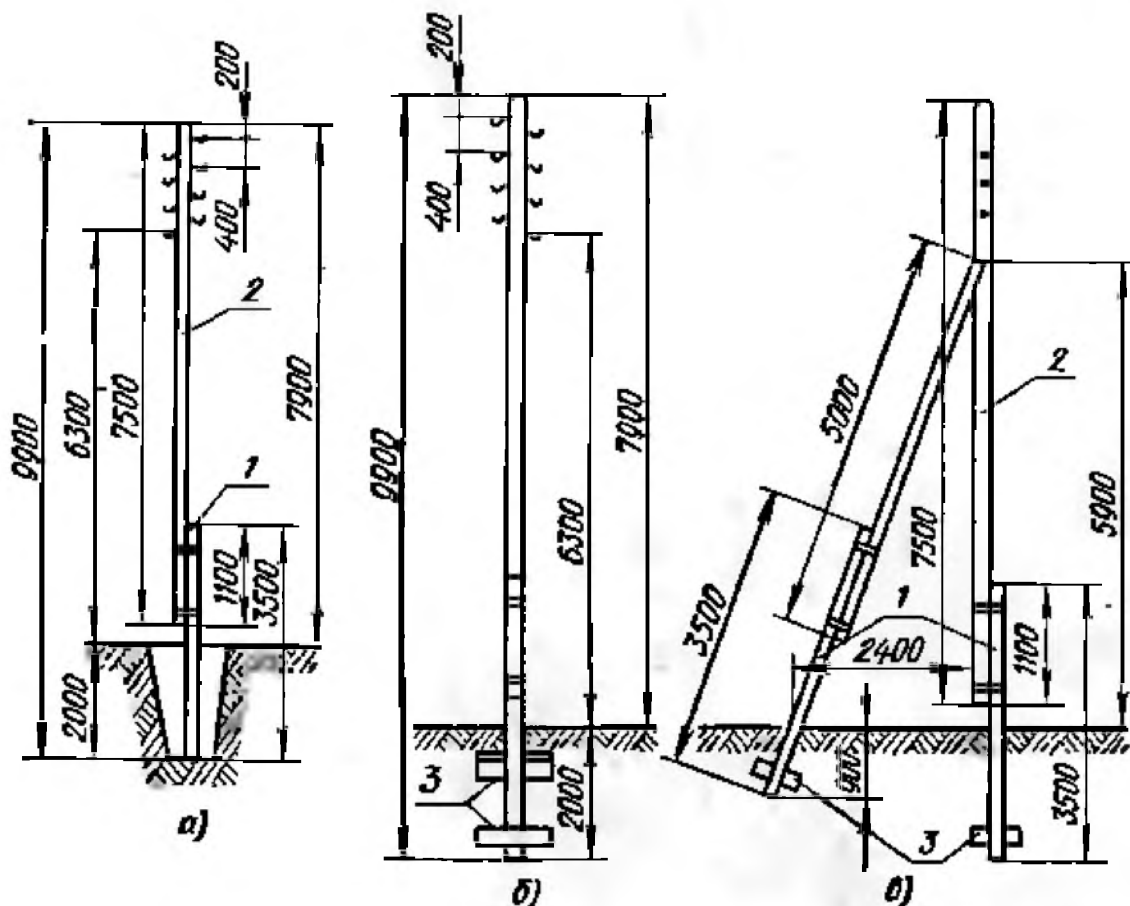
Деревянные опоры воздушных линий электропередачи напряжением до 1000 В:
